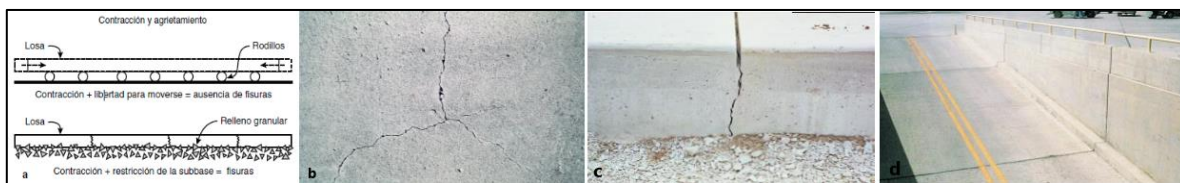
Condiciones para la propagación de fisuras (grietas) por contracción por secado. Fuente: propia.
